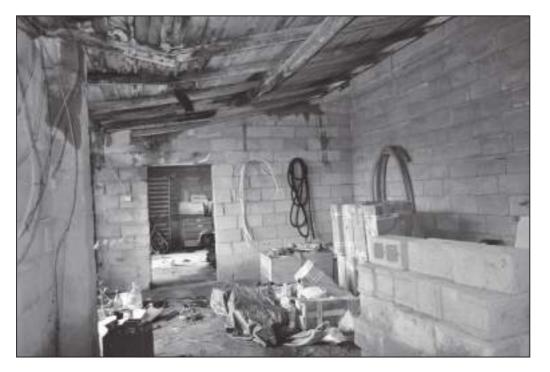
Dettagli del degrado degli elementi strutturali della copertura
